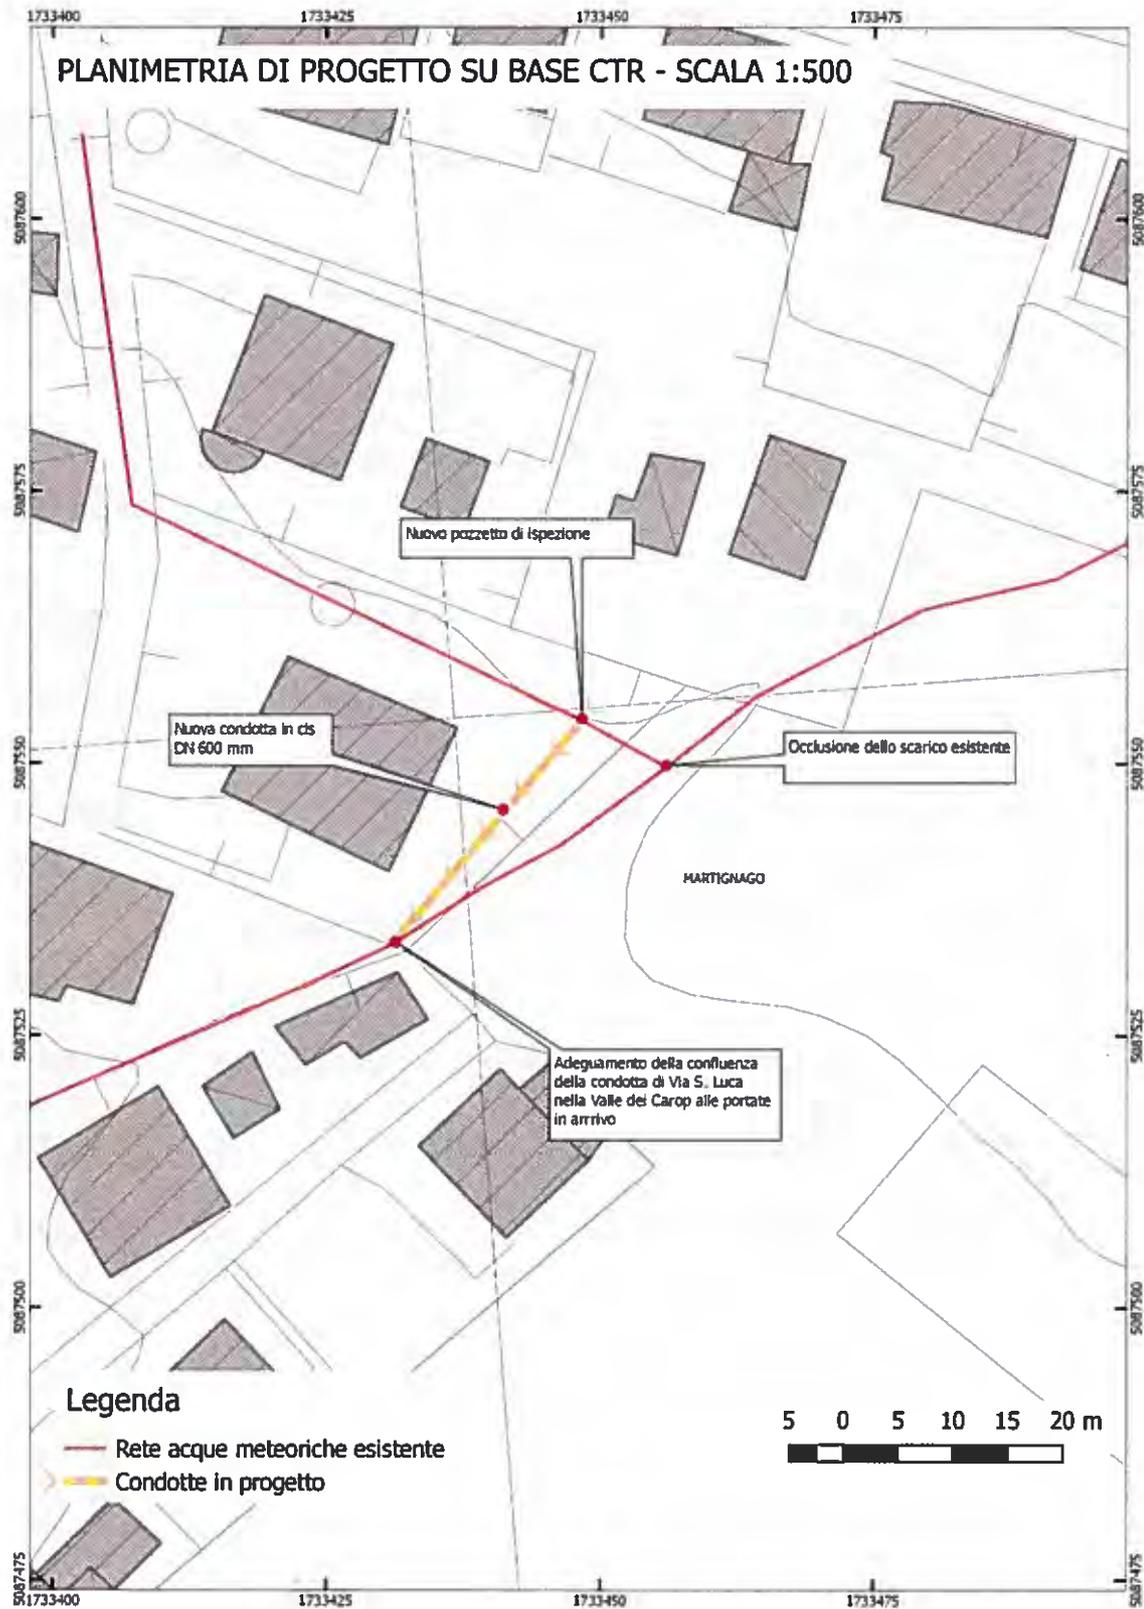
Intervento n.11 – Sistemazione nodo idraulico di Via S. Luca- Planimetria di progetto
